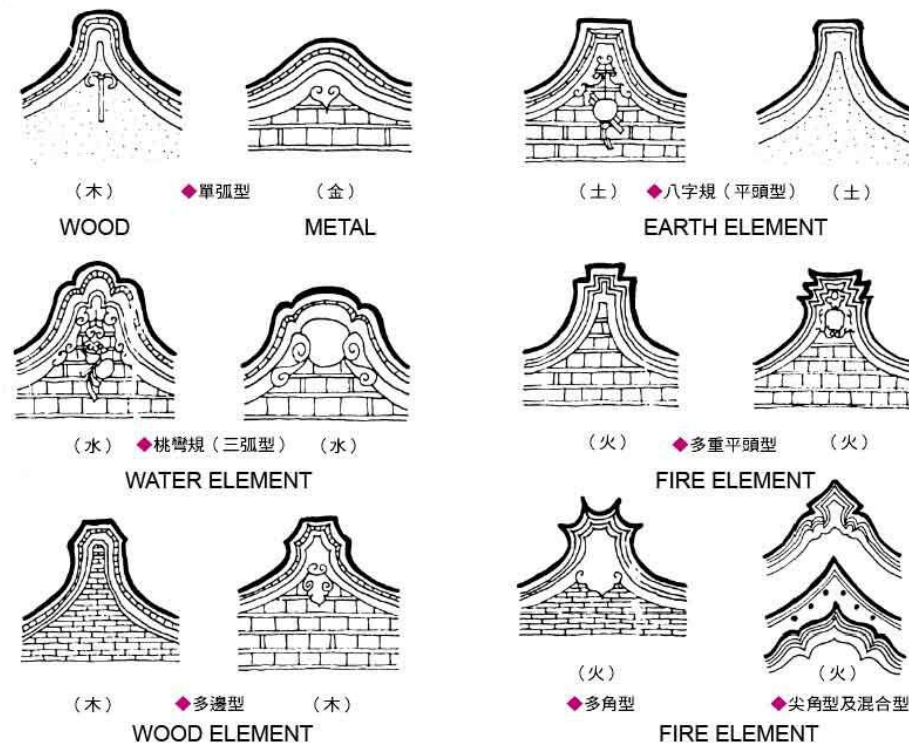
Bentukan struktur bangunan tionghoa Lasem
